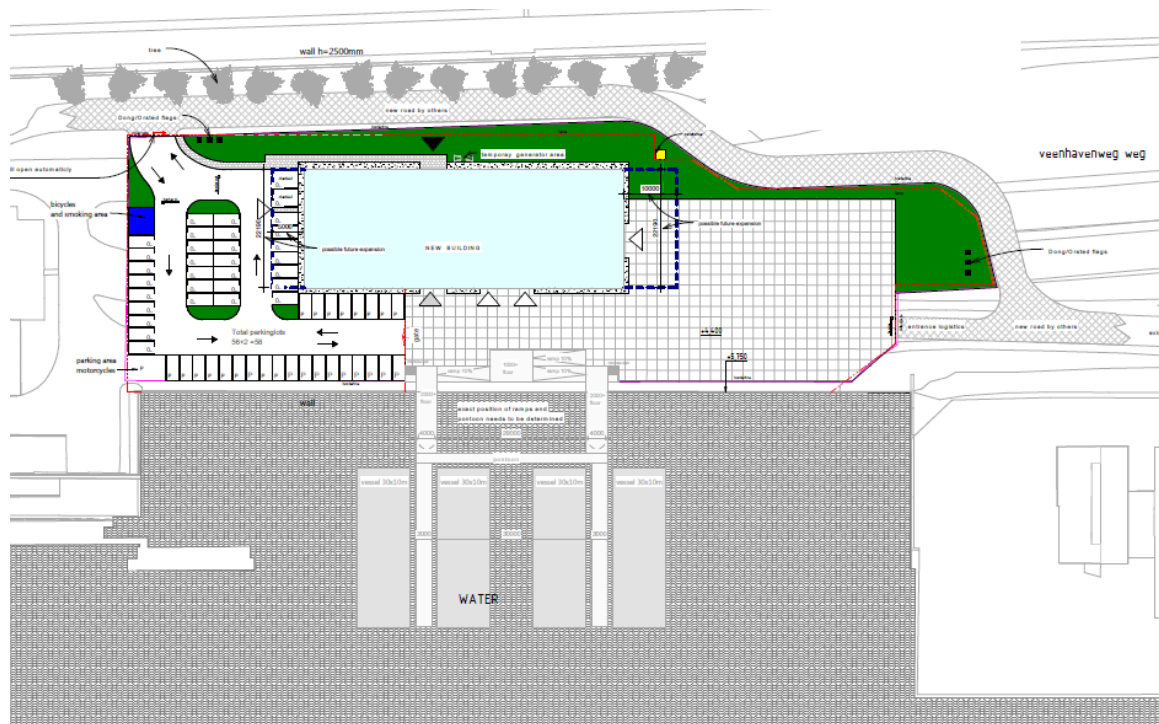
Impressie van het plangebied (september, 2016)
